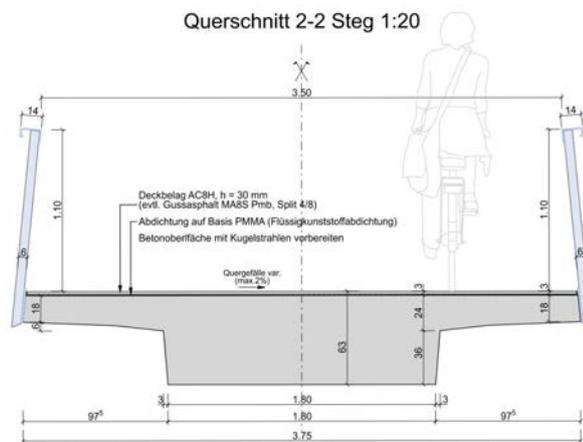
Brückenquerschnitt des Haslachstegs, Littenbach
